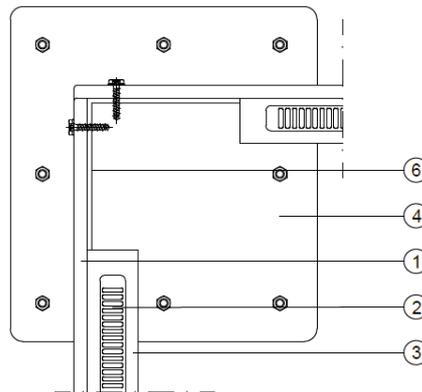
Dettaglio tipologico installazione cor-ten – Pianta - Connessione angolare
